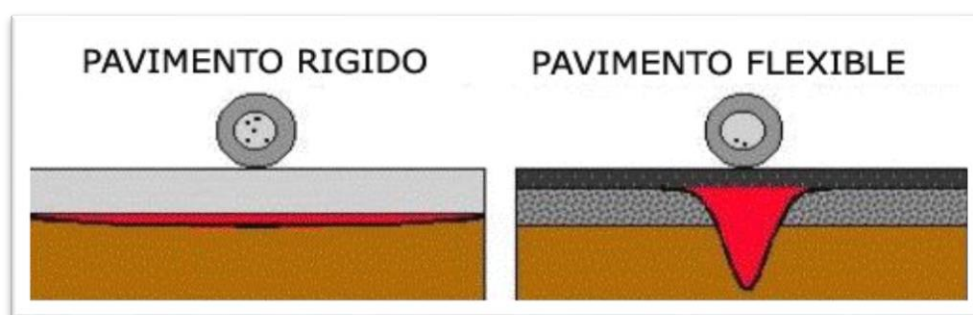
Flexión entre pavimentos Rígido -Flexible.
